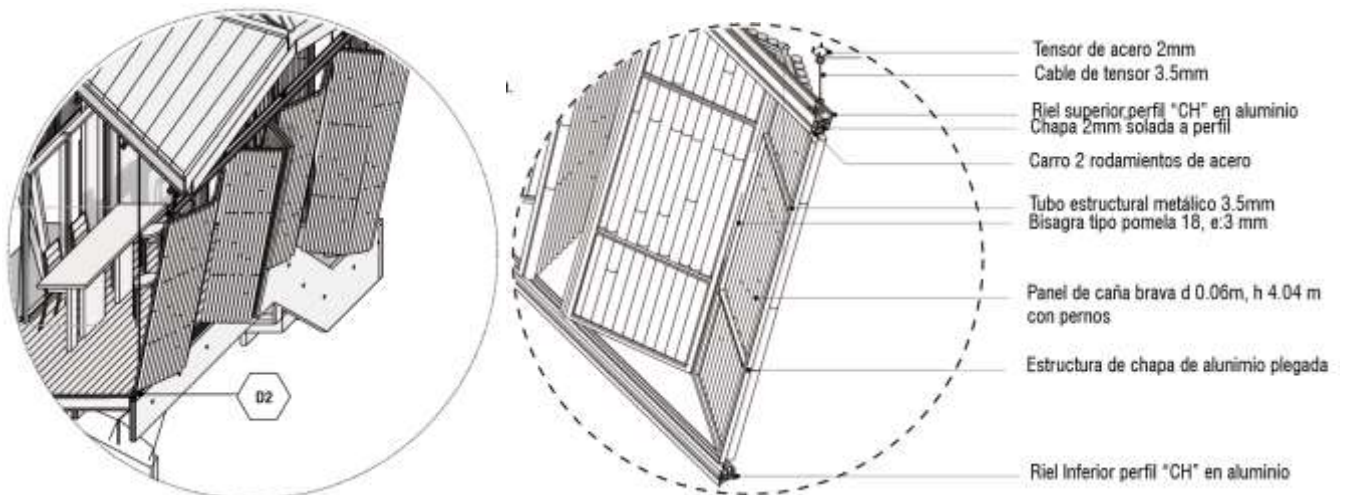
Detalle de fachadas con paneles de caña brava. Autoría propia (2020).
